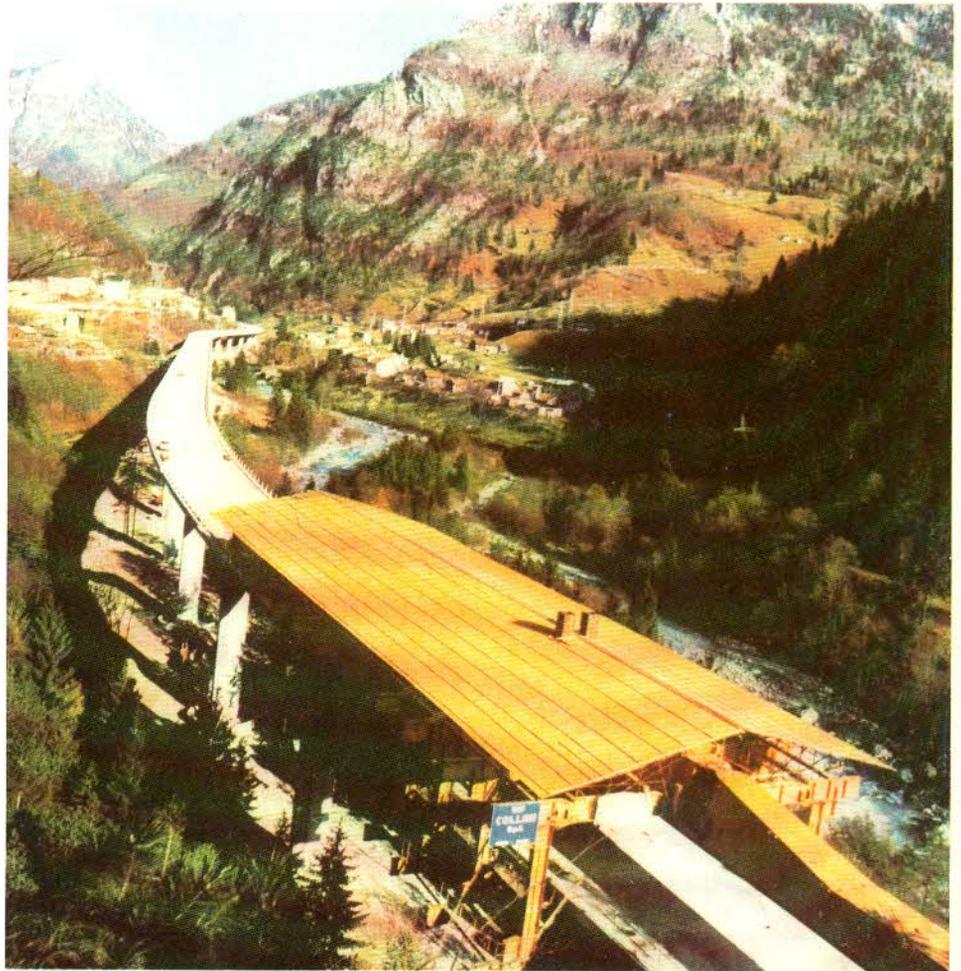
Vista generale del viadotto di Pietratagliata. In primo piano il carro ponte a centina mobile autovarante. Sullo sfondo a destra l'abitato di Pietratagliata □ General view of Pietratagliata viaduct under construction. The Pietratagliata village on the right side
